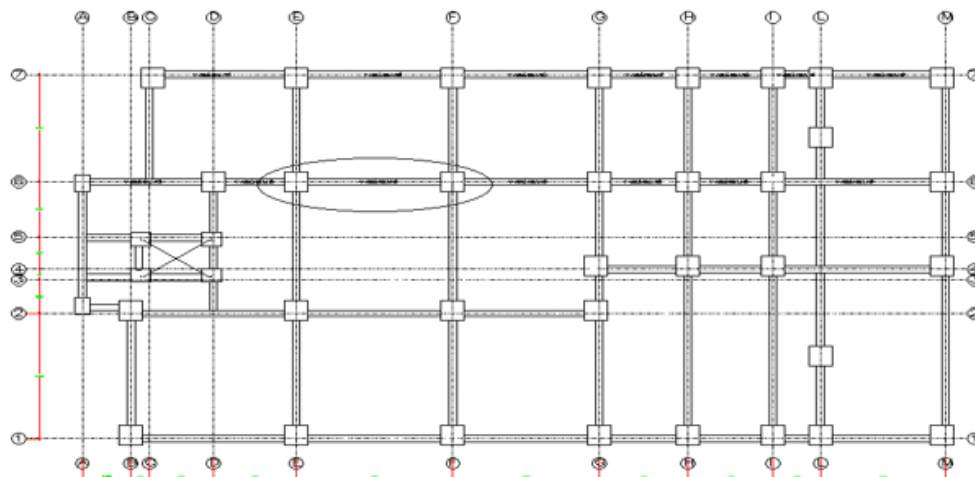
Viga de Aislamiento ejemplo sección 0.40m x 1.20m
